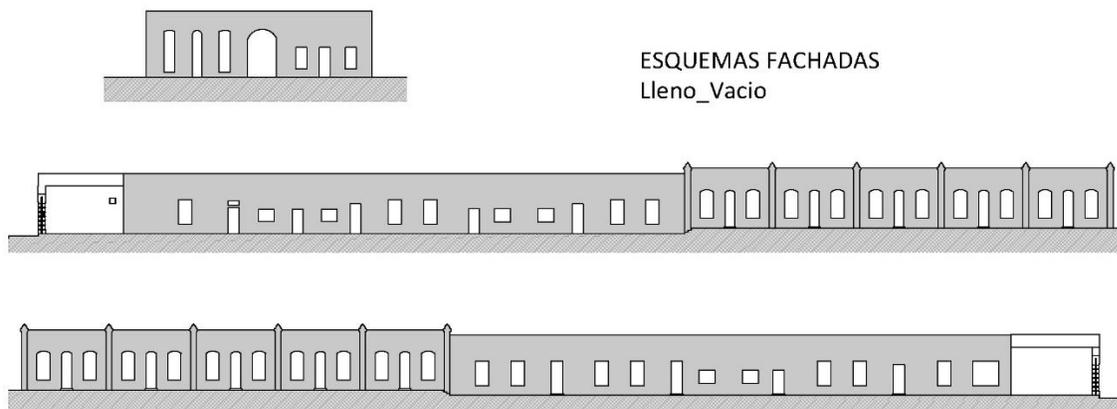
Esquema de fachadas consideradas para el cálculo de porcentajes.
